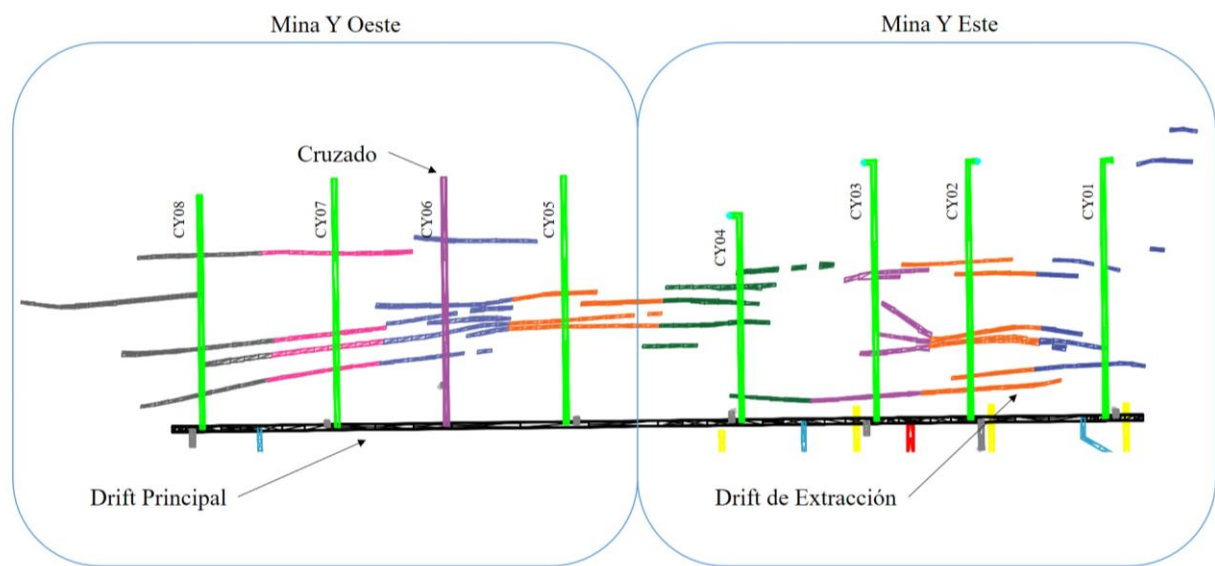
Vista en planta nivel 1,175 m, *Mina Y*.
